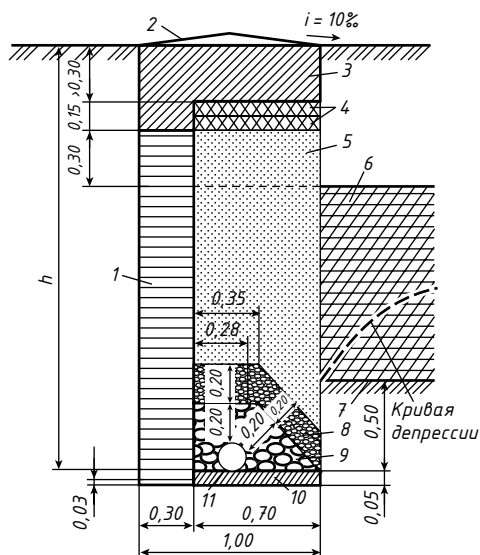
Дренаж, перехватывающий грунтовую воду на откосе выемки:
